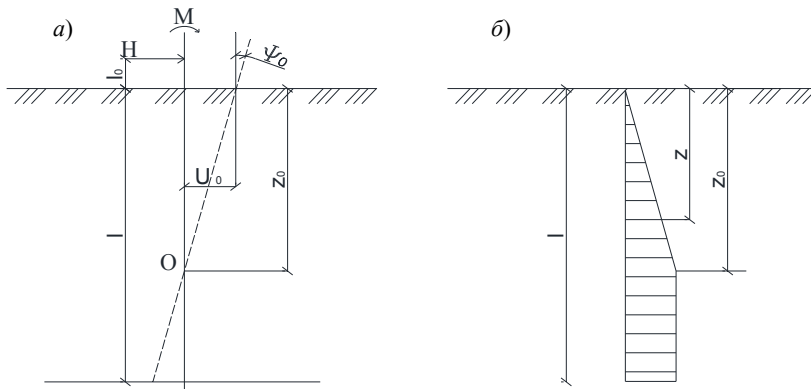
Схема к расчету пирамидальной сваи при действии горизонтальной нагрузки:
